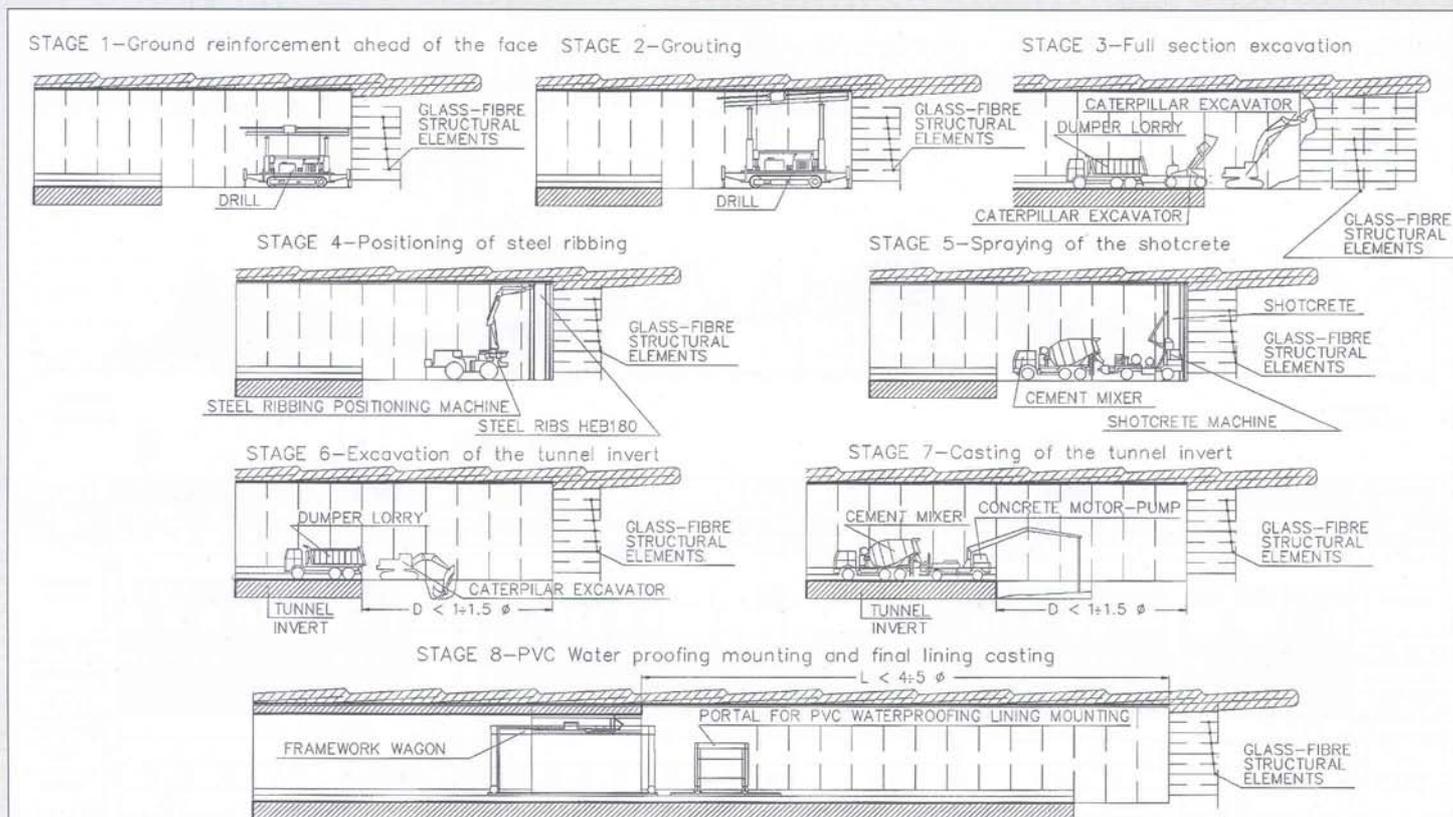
Fasi costruttive per la sezione tipo C2. Construction stages for the C2 type section.
